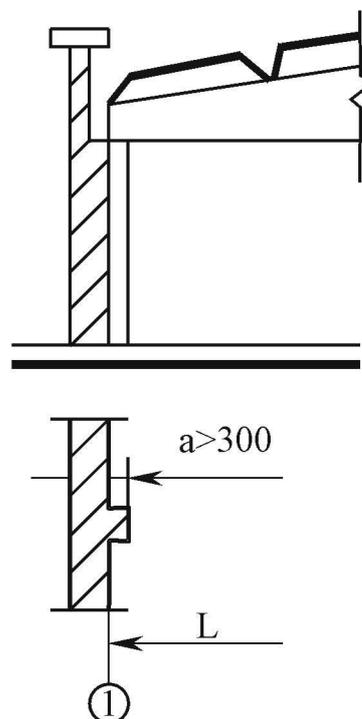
Схема привязки стен с пилястрами бескаркасного здания к координационным осям
